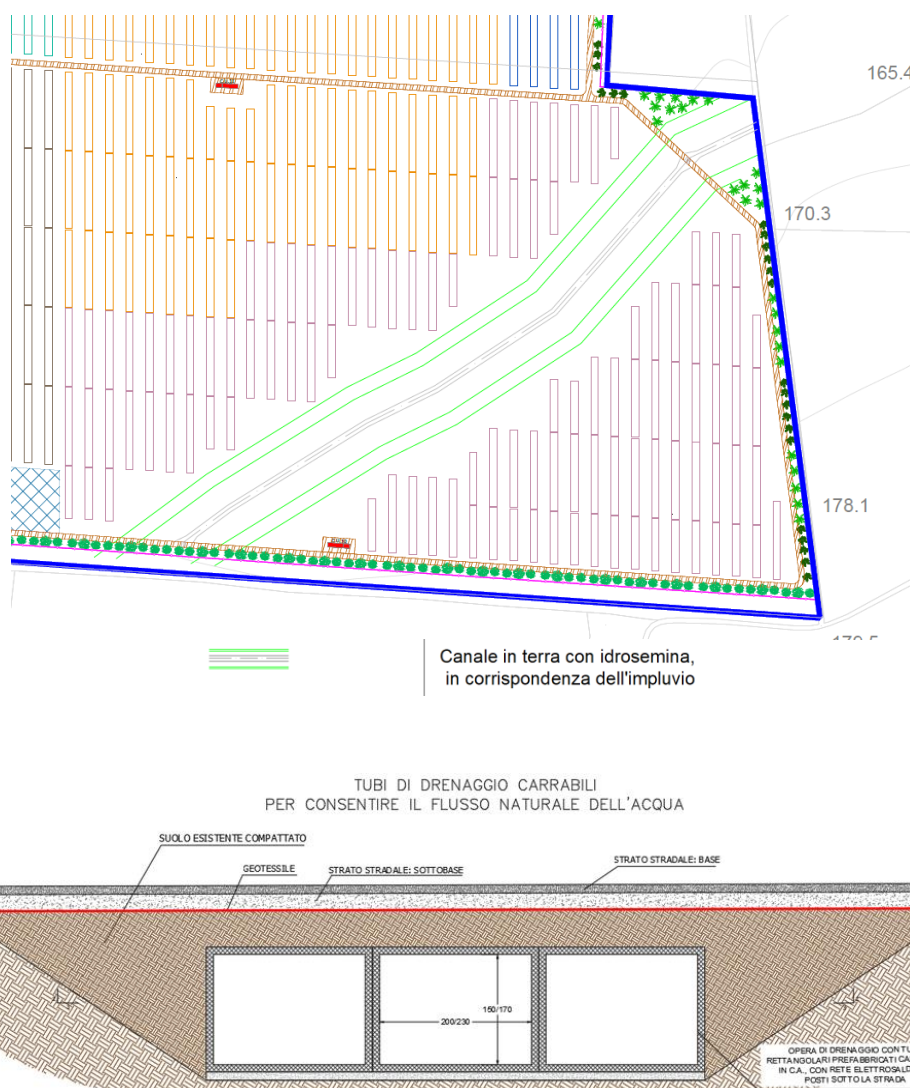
Porzione sud-est dell'area d'impianto in planimetria ed attraversamento tipo, sotto le strade: sia per la strada a nord che per quella a sud
